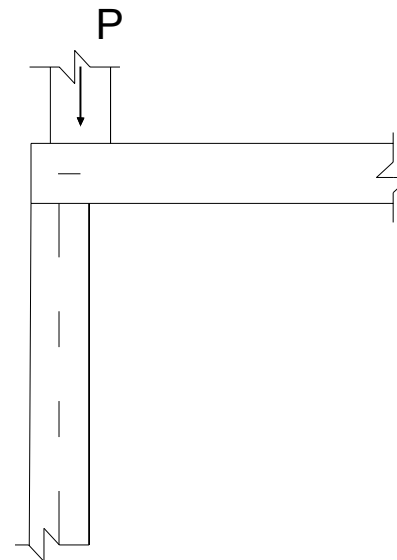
Descarga de losa extrema en muro con cavidad.
